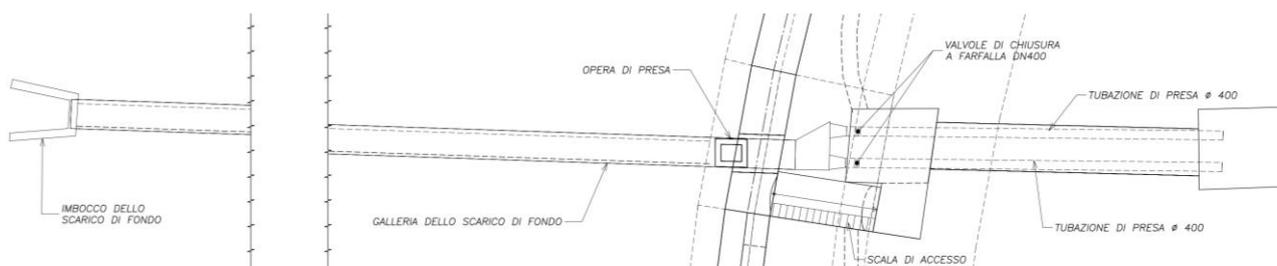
Planimetria dello scarico di fondo e opera di presa
